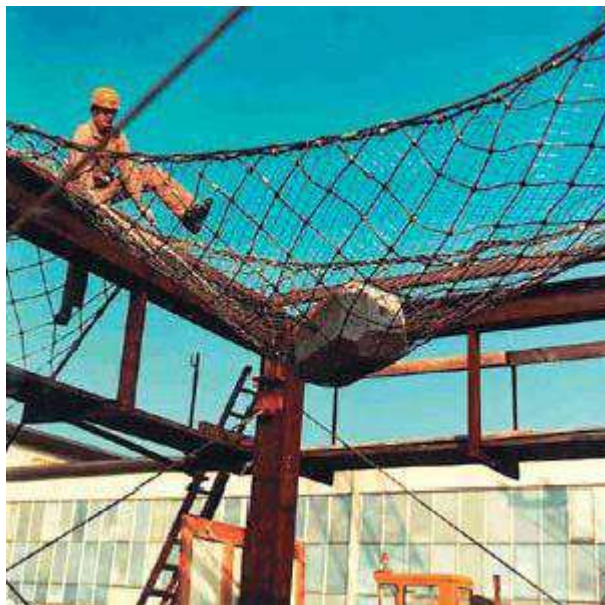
Primera prueba de barreras con uso de elementos de frenado.
